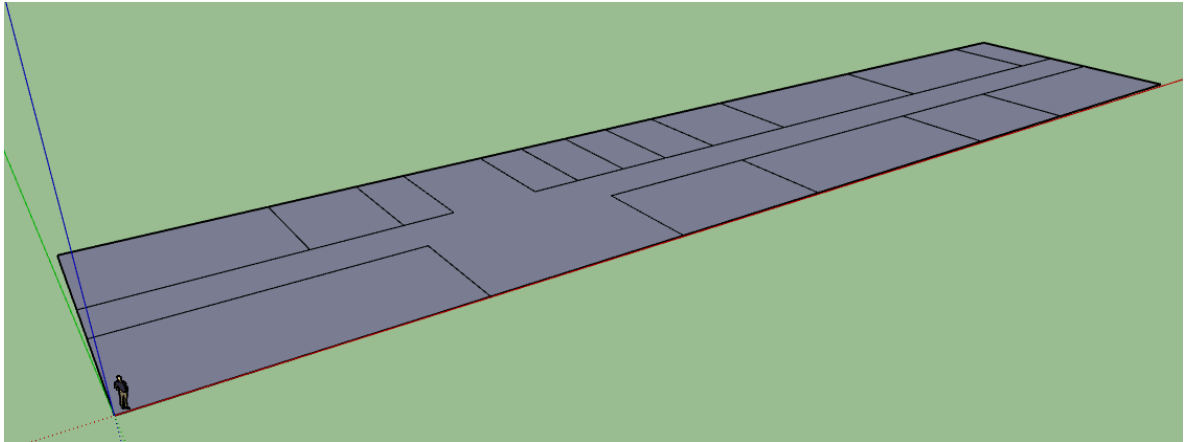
IX, Vista superior planta baja edificio sin proyectar
